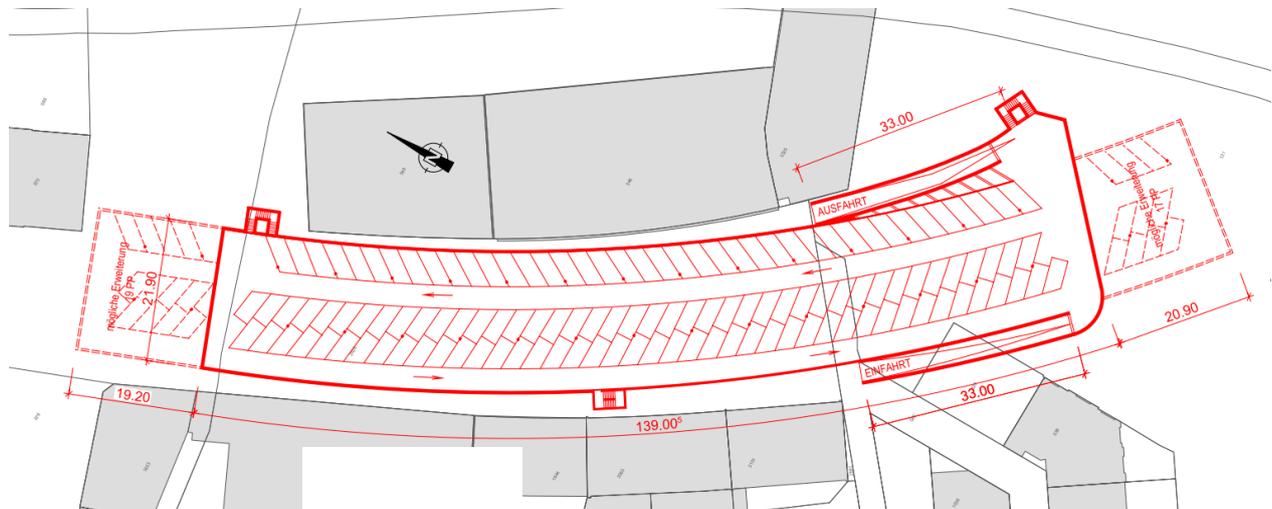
Ausschnitt Situation Variante Hallwiler 1.1 Grundriss Parkgeschoss
